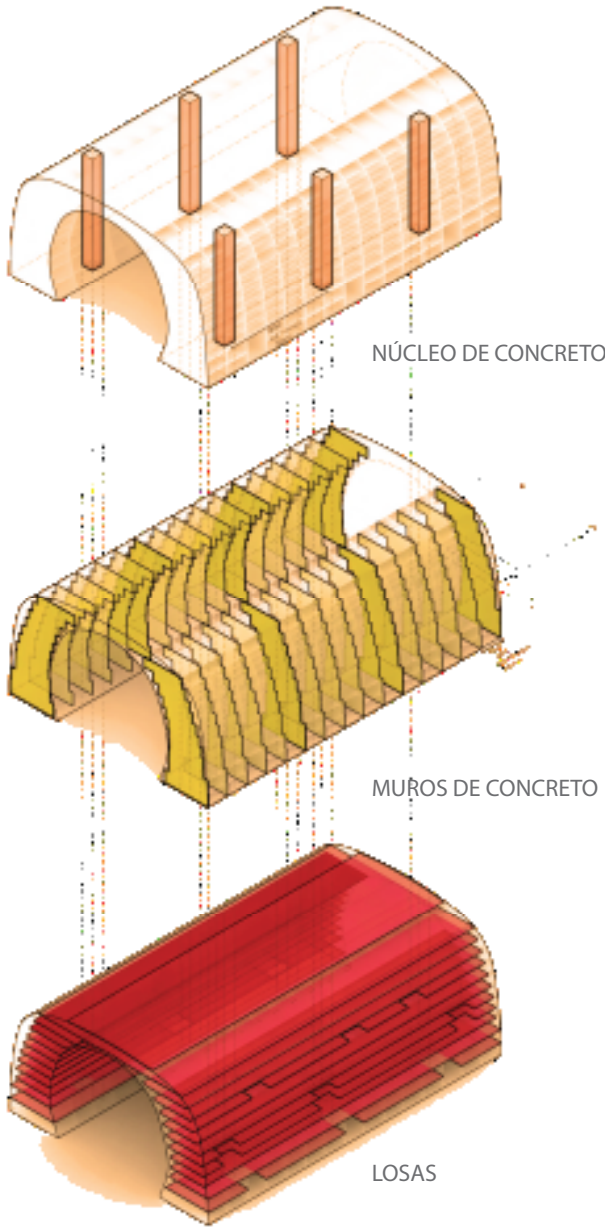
AXONOMETRÍA ESTRUCTURAL
